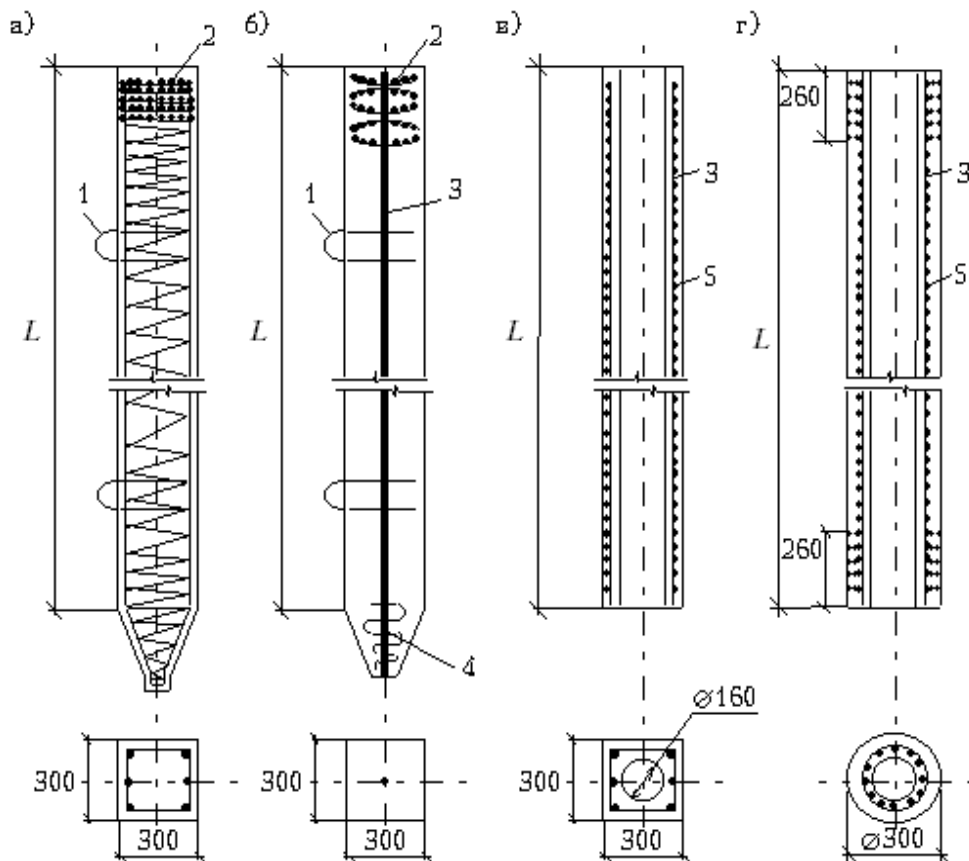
а – призматична з поперечним армуванням стовбура; б – те ж, без поперечного армування стовбура; в – те ж, з круглою порожниною; г – порожниста кругла; 1 – стропувальна петля; 2 – арматурні сітки голови; 3 – поздовжня арматура; 4 – спіраль вістря; 5 – поперечна спіральна арматура
